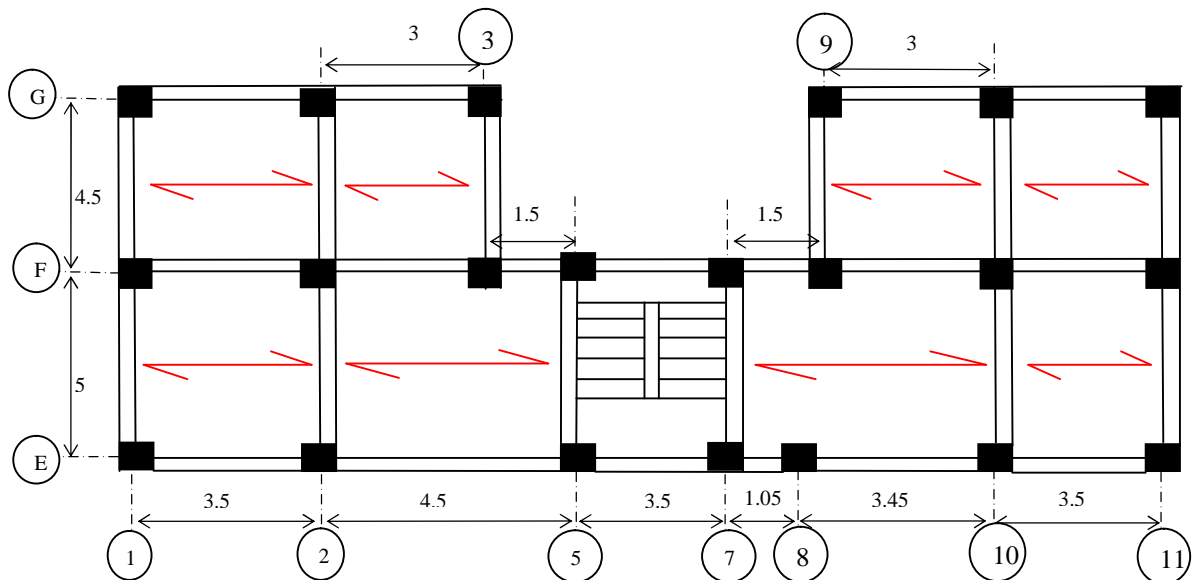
Sens de disposition des poutrelles de 9^{eme} et 10^{eme} étage.
